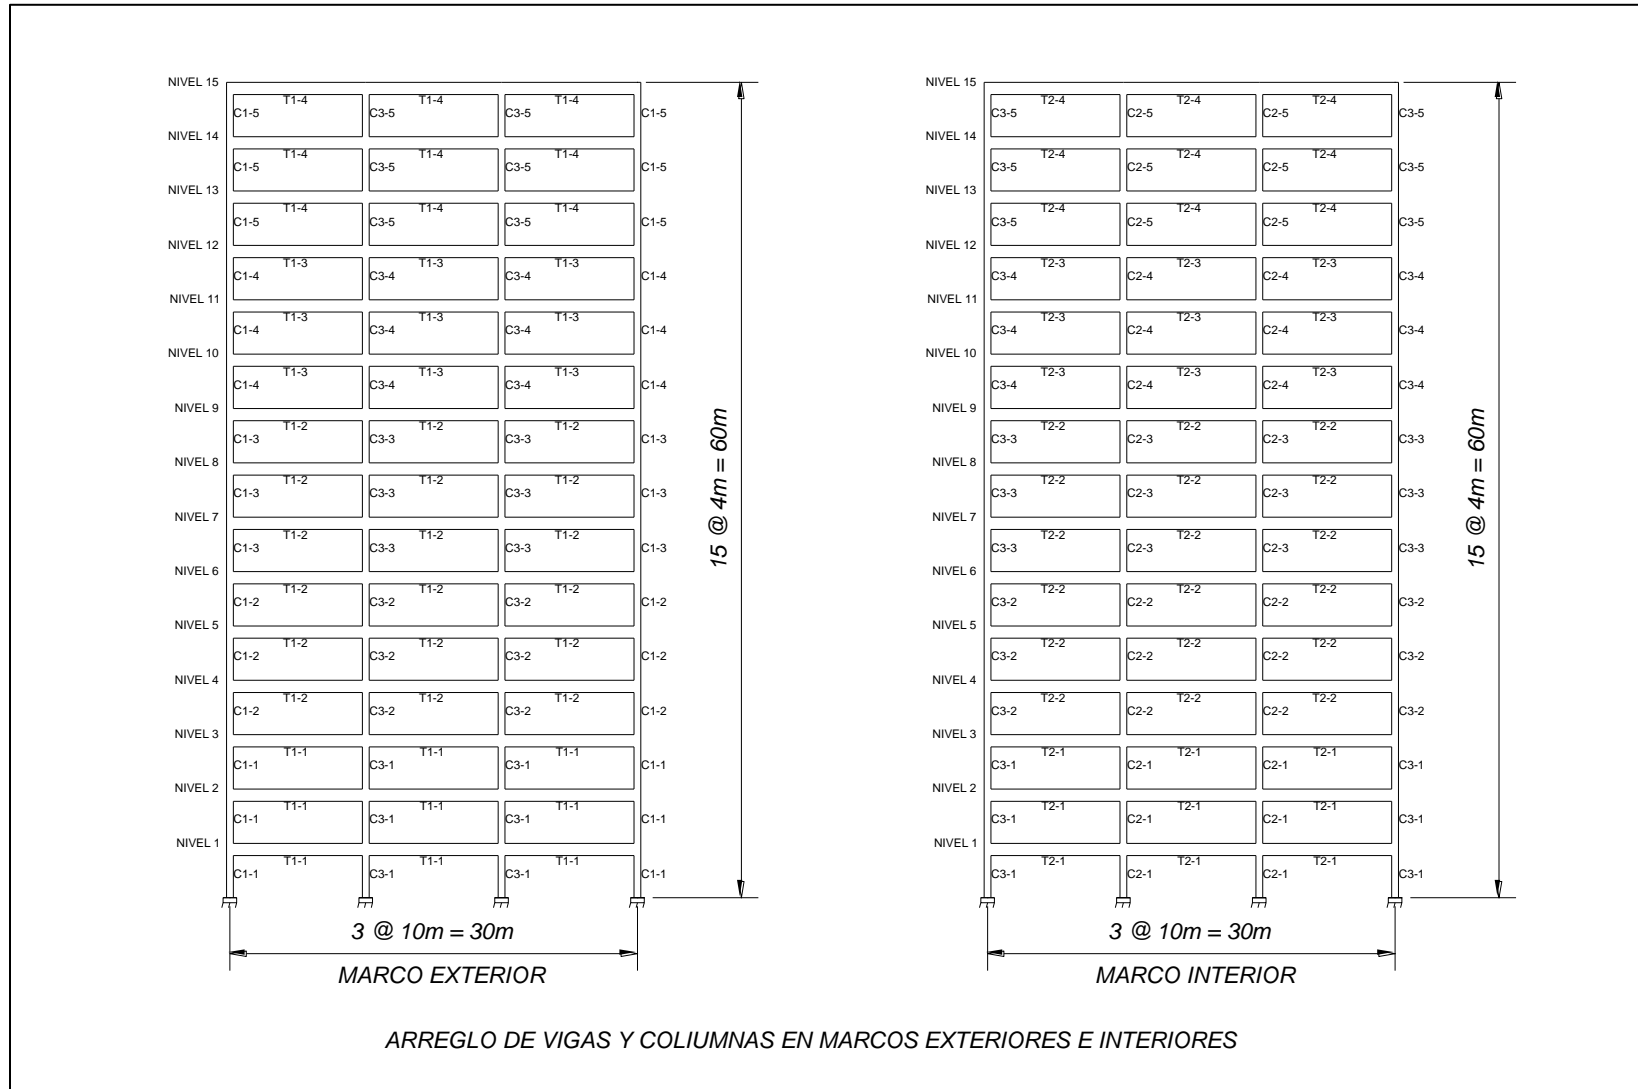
Detalles estructurales del edificio de 15 niveles diseñado con el ACI318-08
